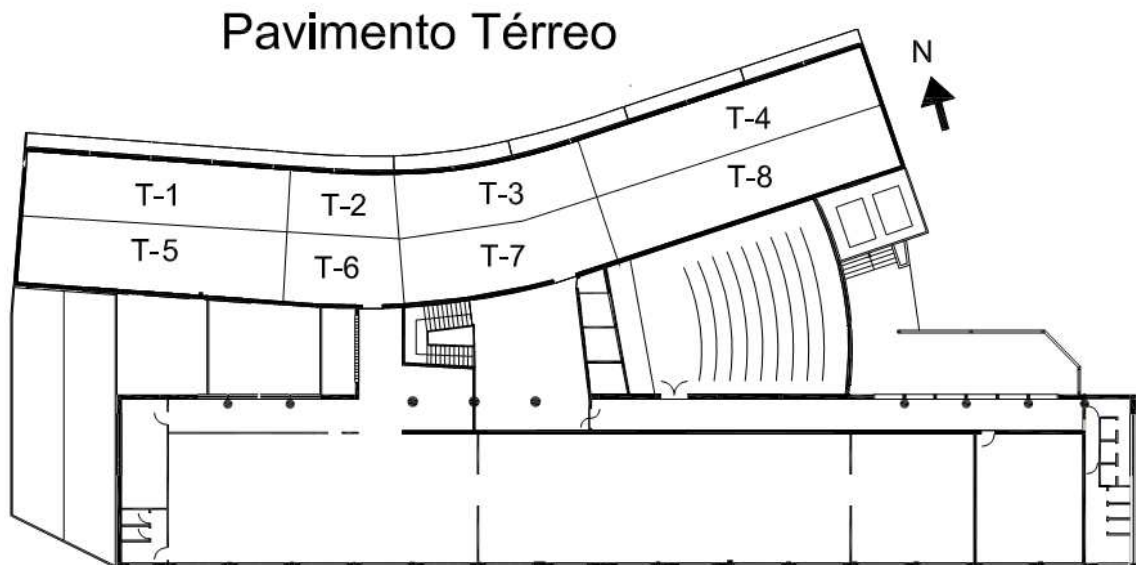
Planta baixa do pavimento térreo com as 8 zonas térmicas.
